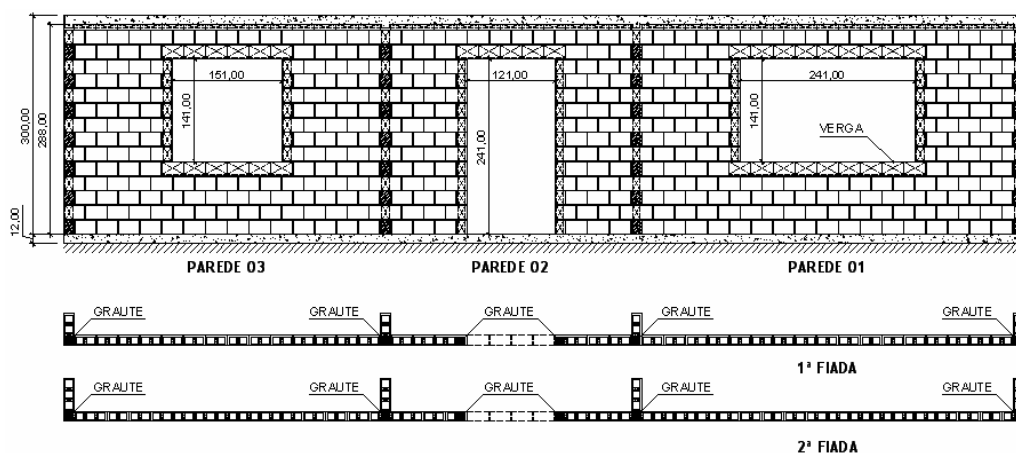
Paredes 03, 02, e 01 – Detalhe da 1ª e 2ª fiadas e elevação.
